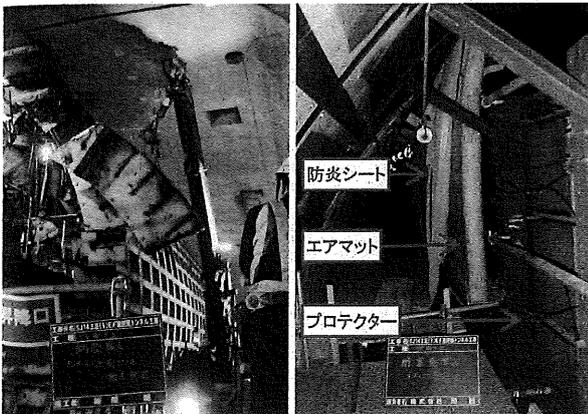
鋼殻主桁の撤去 写真-10 プロテクター閉塞
